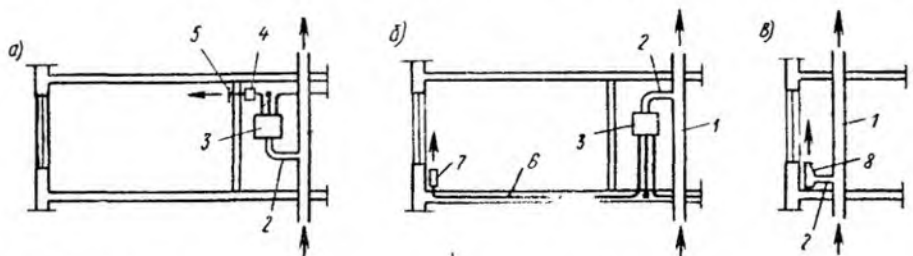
Комбинированное воздушное отопление зданий с централизованной подачей подогретого воздуха по воздуховоду и местным нагреванием
